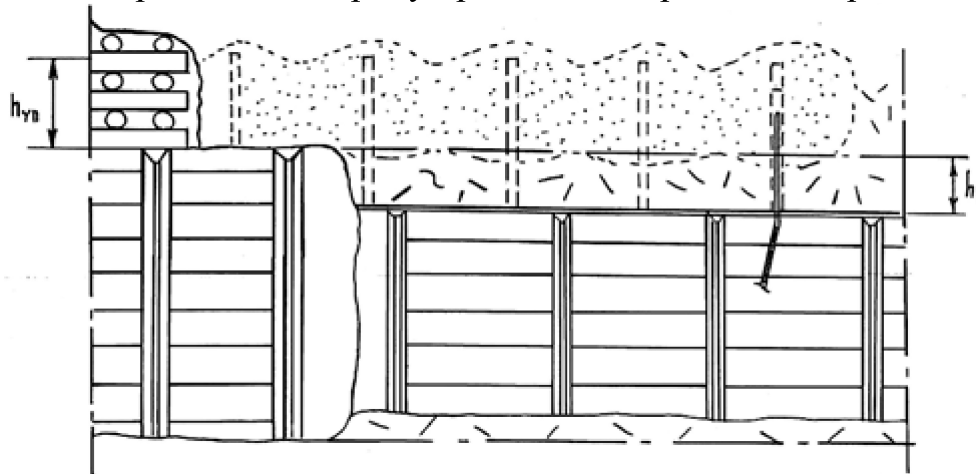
Параллельная технологическая схема перекрепления выработки с использованием инъекционного укрепления
